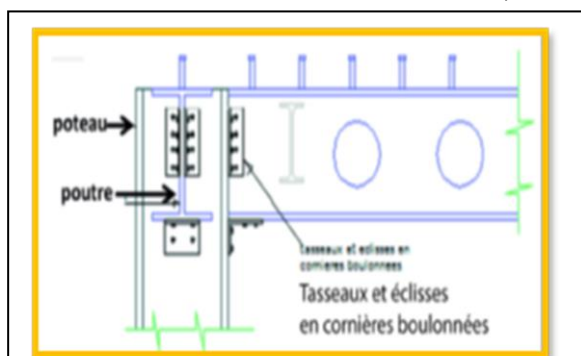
schéma présentant la jonction poteau-poutre alvéolaire
